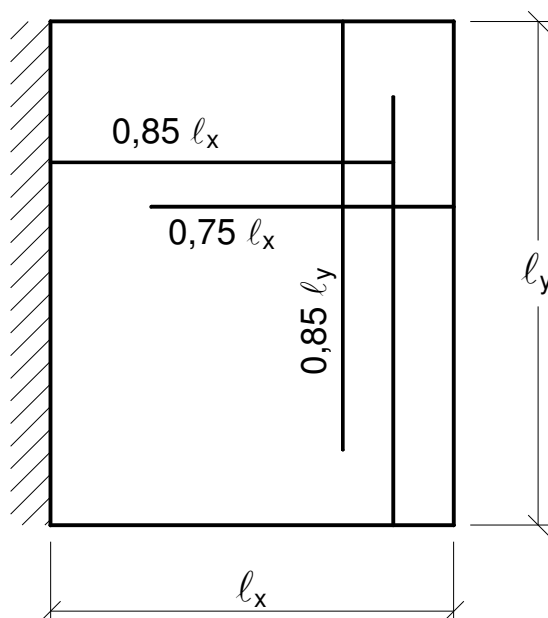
Comprimento mínimo das barras da armadura positiva entre uma borda apoiada e outra engastada.
